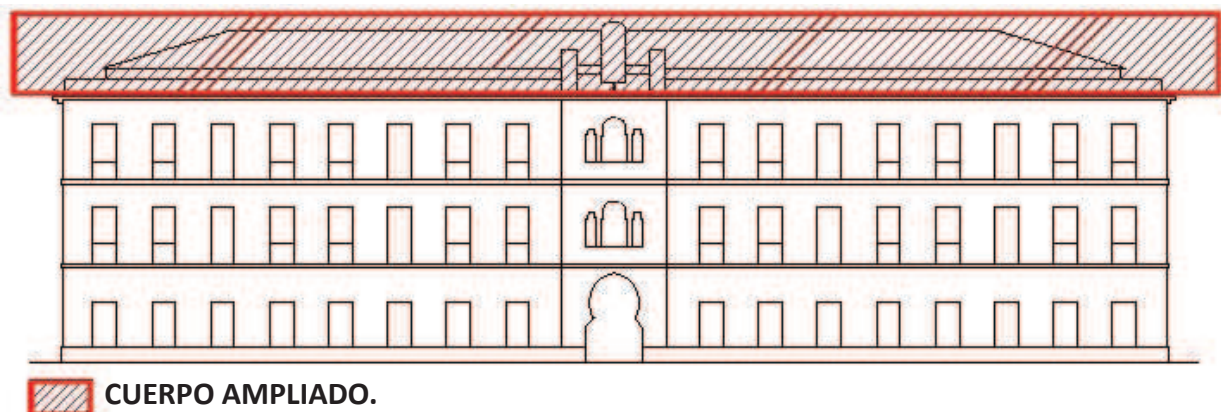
Esquema de fachada Ppal. Pabellón 4.
